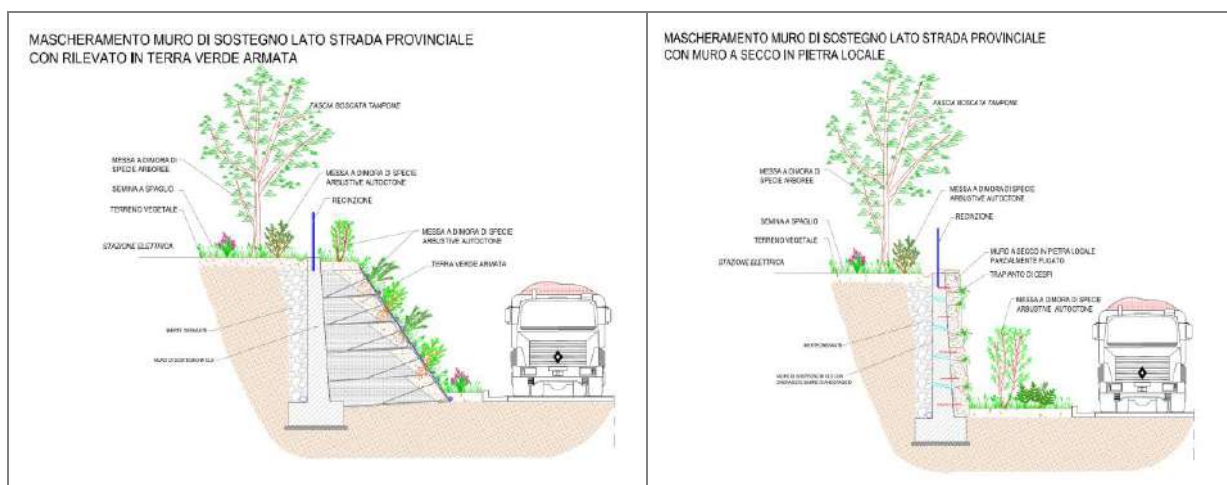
Alternativa progettuale 1. Mascheramento del muro di sostegno lato strada con rilevato in terra verde armata. (Progetto fattibilità Terna Spa)
